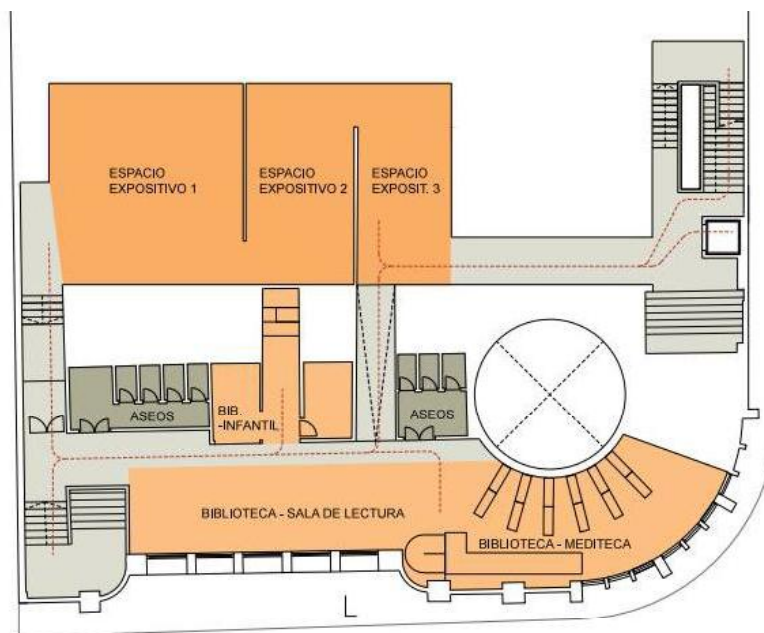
PLANTA SEGUNDO NIVEL
